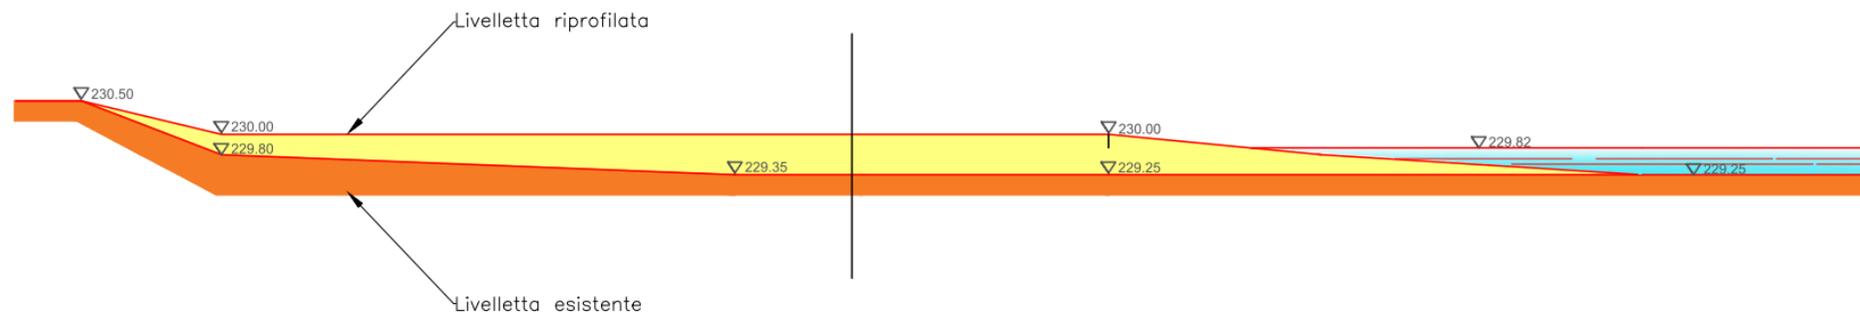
INTERVENTO DI RIPROFILATURA STRADA DI ACCESSO ALLE ABITAZIONI DALLA SS26
